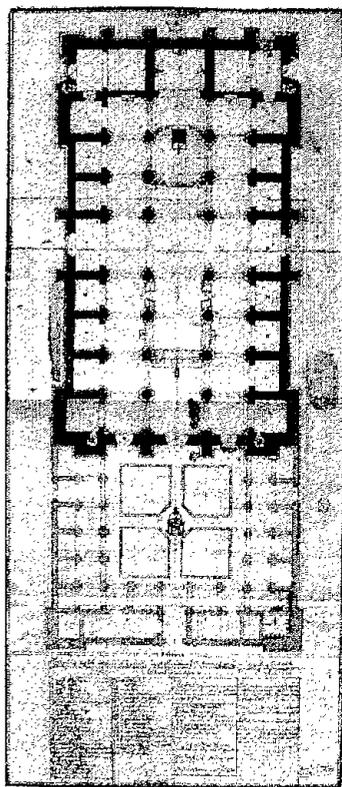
Planta de la Catedral de Puebla, Archivo General de Indias, Sevilla.
